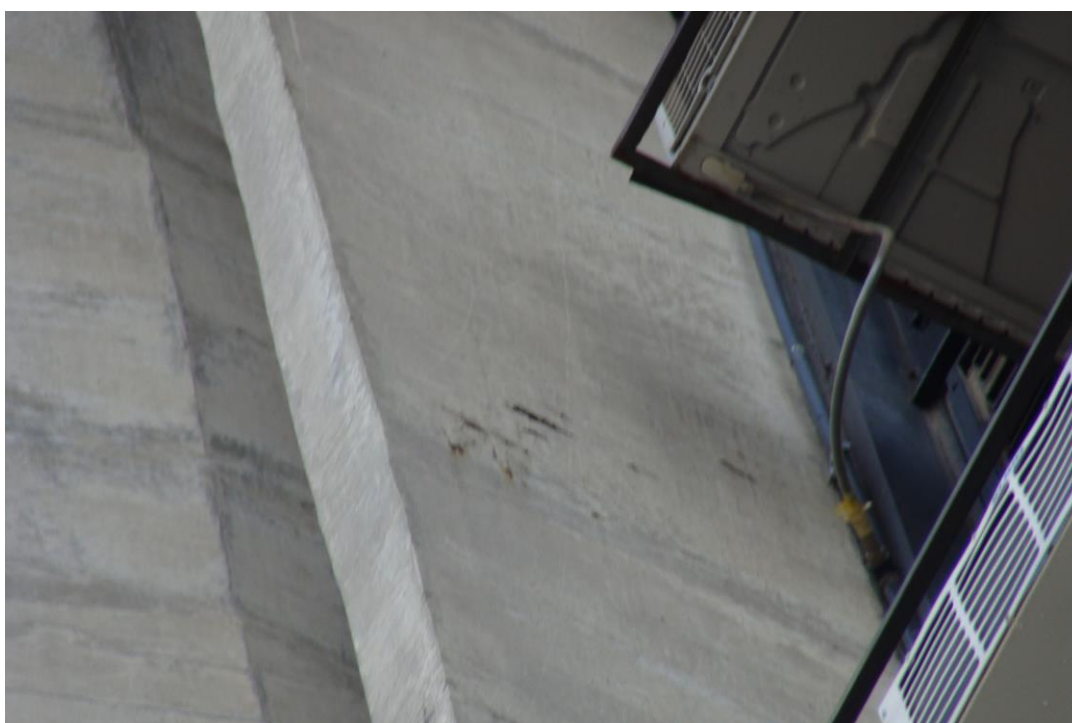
Armadura exposta pilar P12 (1º pavimento) (19/11/2013)
